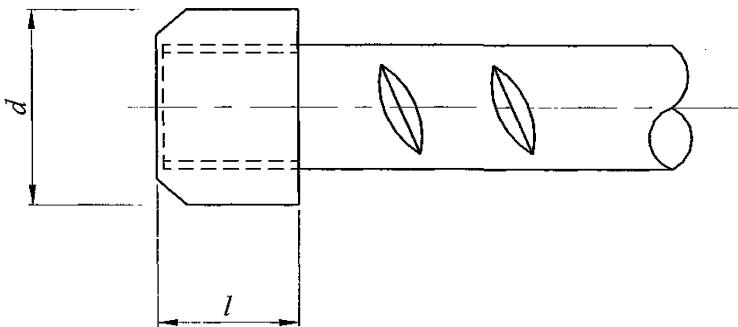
Свариваемое соединение арматурных стержней с цилиндрической резьбой
